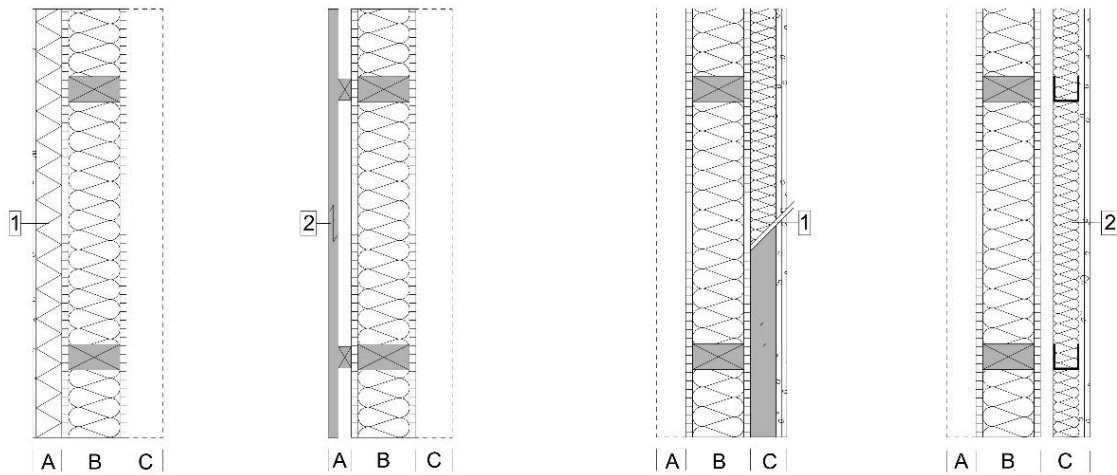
Wandaufbauten im Horizontalschnitt, links: 1) Kompaktfassade + Kernelement, 2) Hinterlüftete Fassade + Kernelement, rechts: 1) Kernelement + direkt verbundene Installationsebene, 2) Kernelement + eigenständige (entkoppelte) Installationsebene
